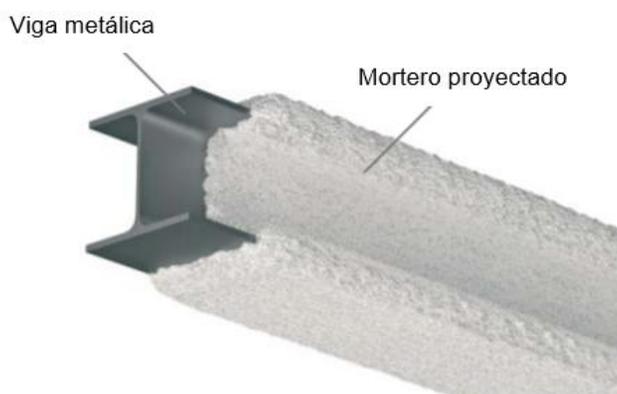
Aplicación de un mortero proyectado sobre una viga metálica (TECRESA, 2011)
